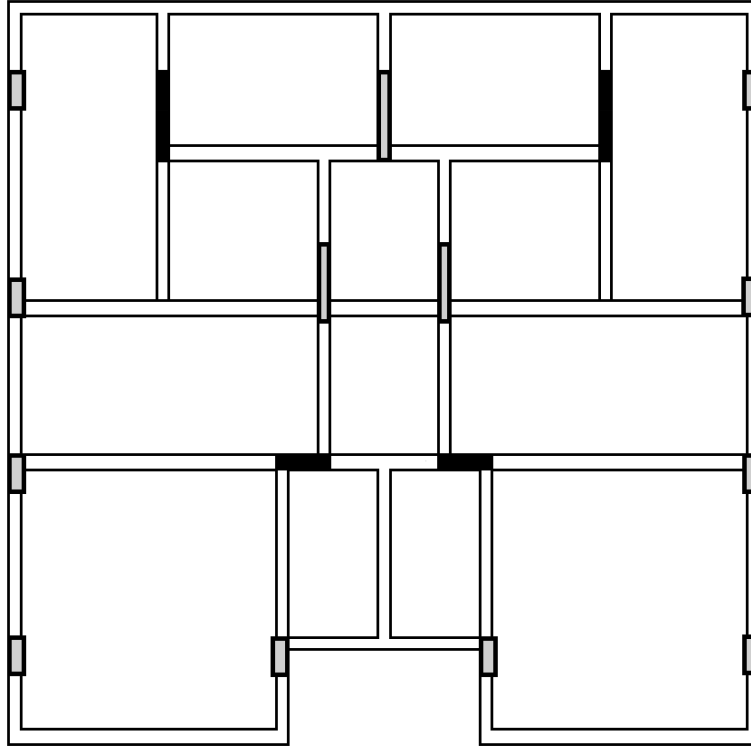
Yapı Tip 2 şematik kalıp planı
